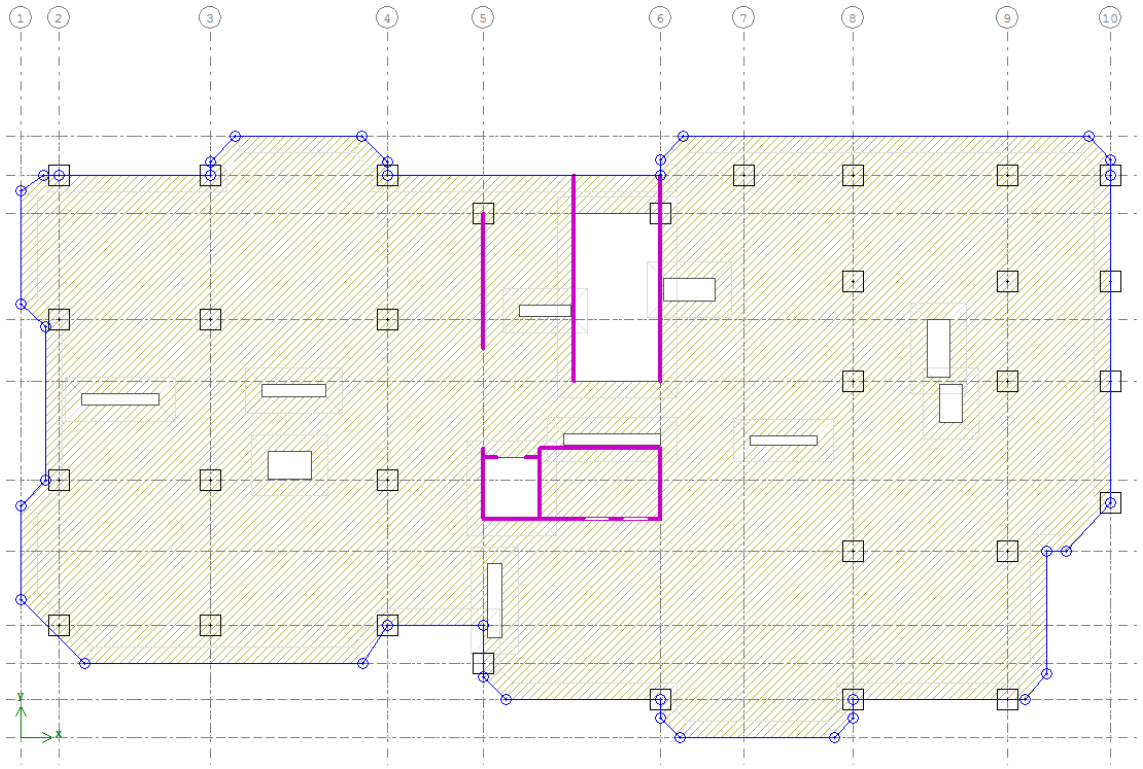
Розрахункова схема для типового поверху житлової будівлі
